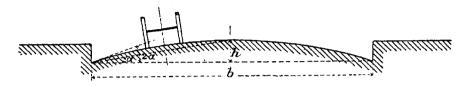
Dachförmige Bildung der Strassenoberfläche.
